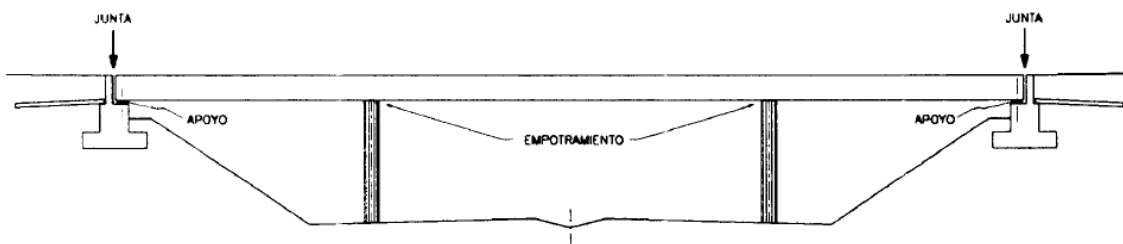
Rodríguez C. (2000), puente mixto tablero empotrado a pilas, ilustración, recuperado de Guía para la concepción de puentes en carreteras
